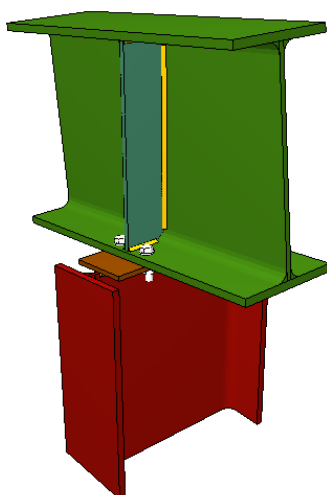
Detalle de la unión en CYPE 3D de Pilar fachada-Jácena.
